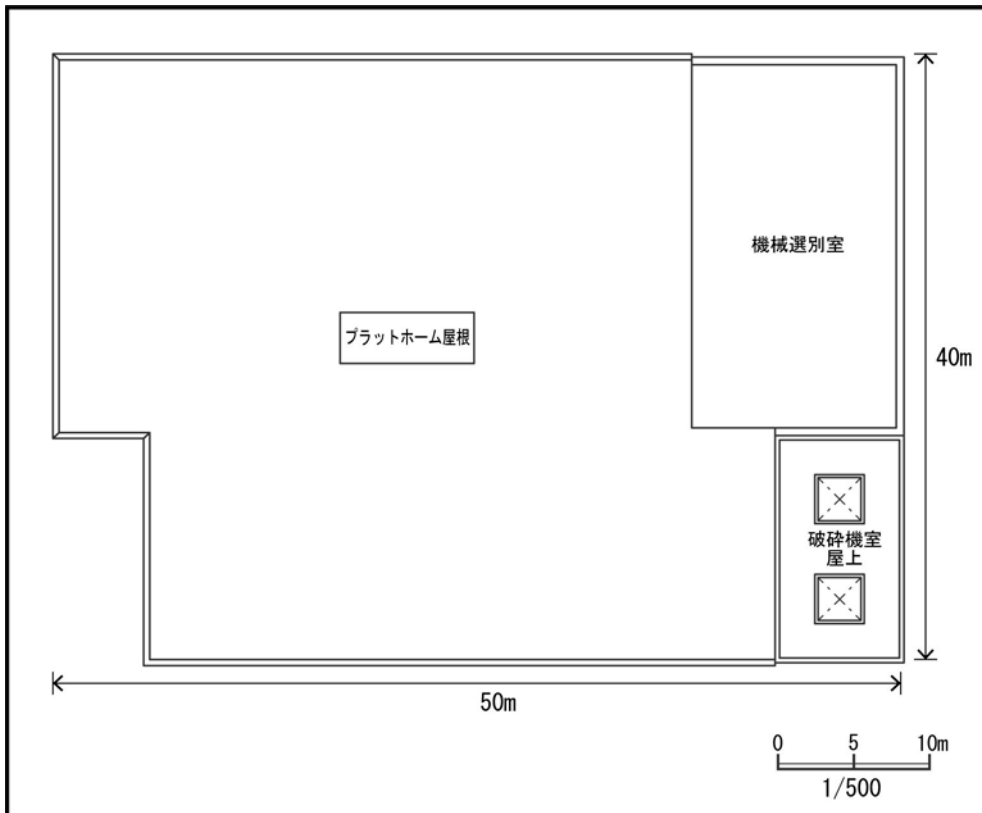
(4) 新施設の平面図（新粗大ごみ処理施設プラント階）
